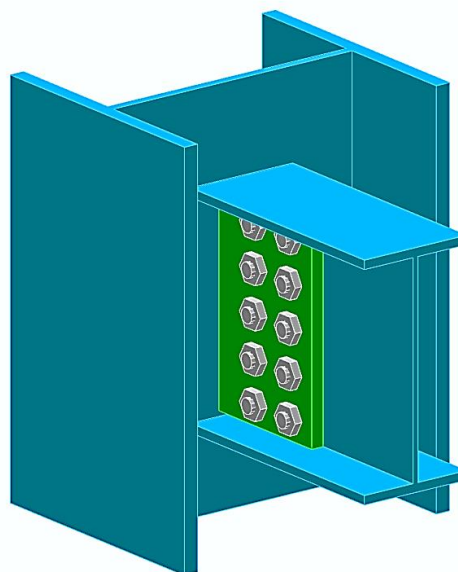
Vue 3D de l'assemblage poteau poutre secondaire
